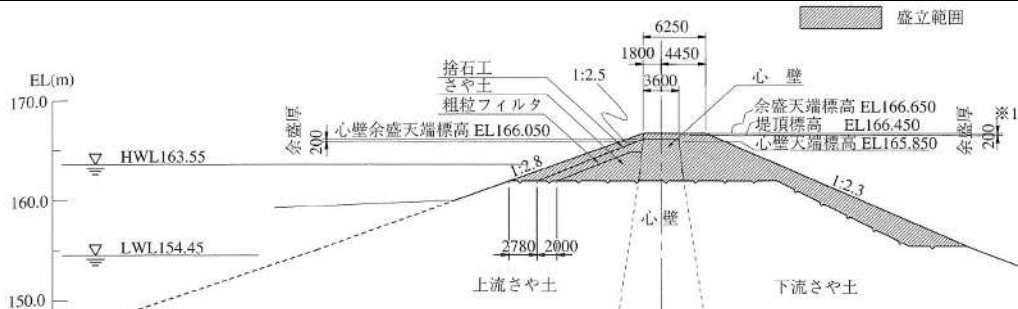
浅河原調整池復旧(補修)横断面図
